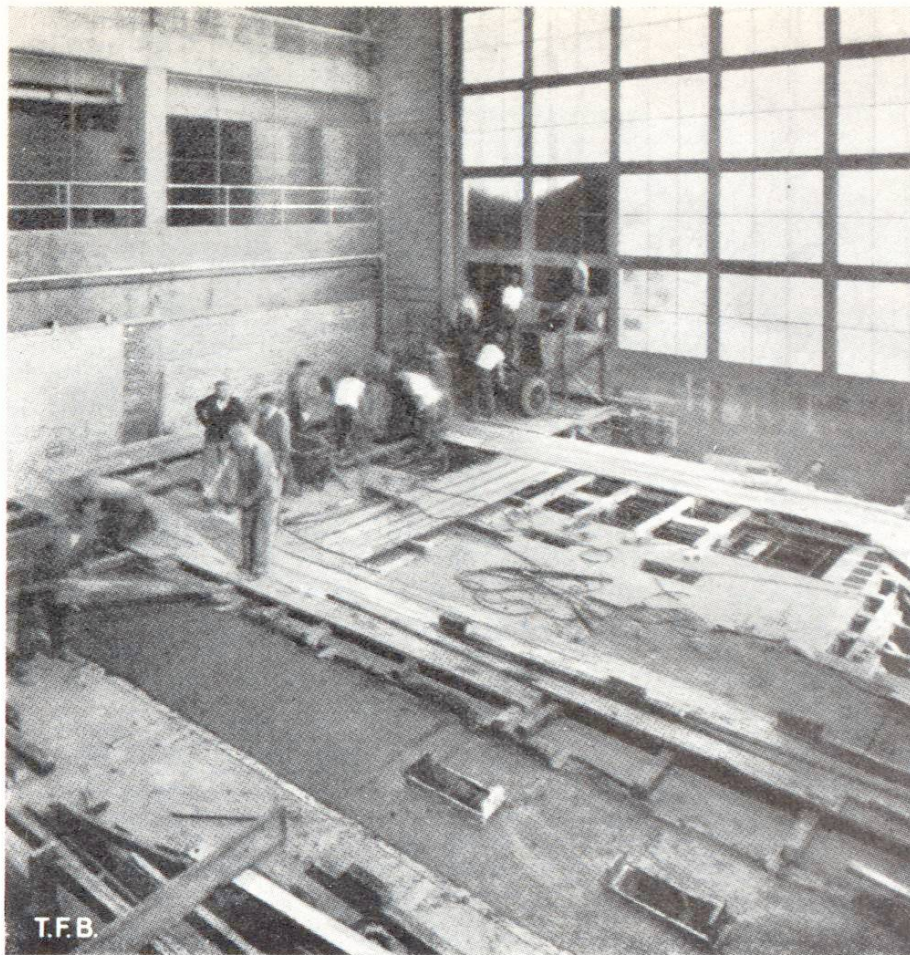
Bétonnage d'une troisième poutre entre deux autres déjà terminées. On remarque les évidements dans lesquels un dispositif permet d'accrocher les poutres pour les soulever
